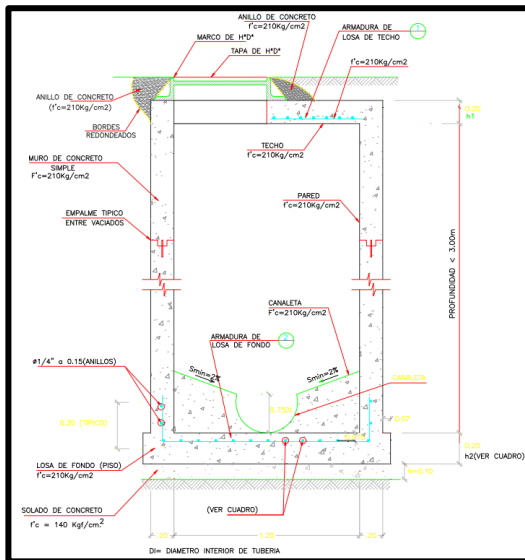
Detalles de construcción del buzón de hormigón (CSN) para alcantarilla.
